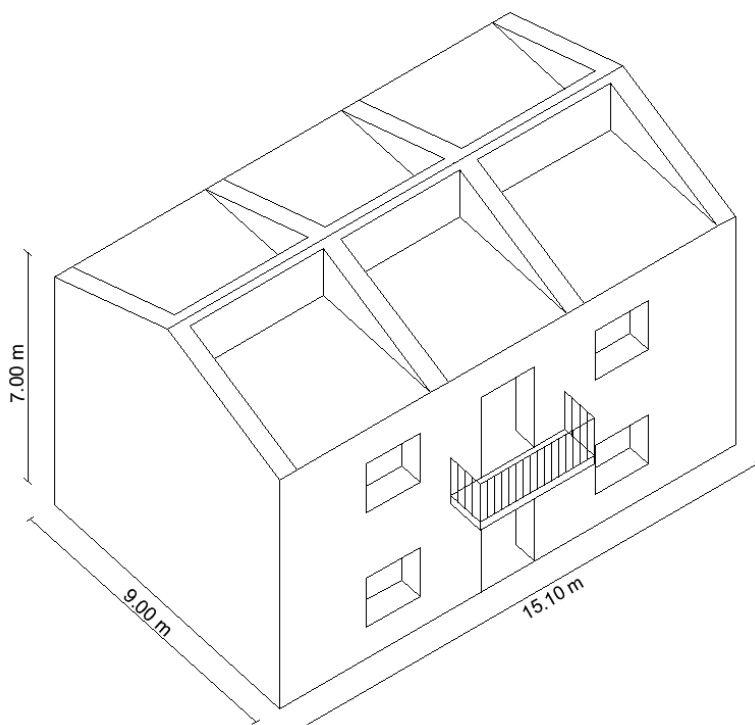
Vista tridimensionale dell'edificio (stato di progetto)
